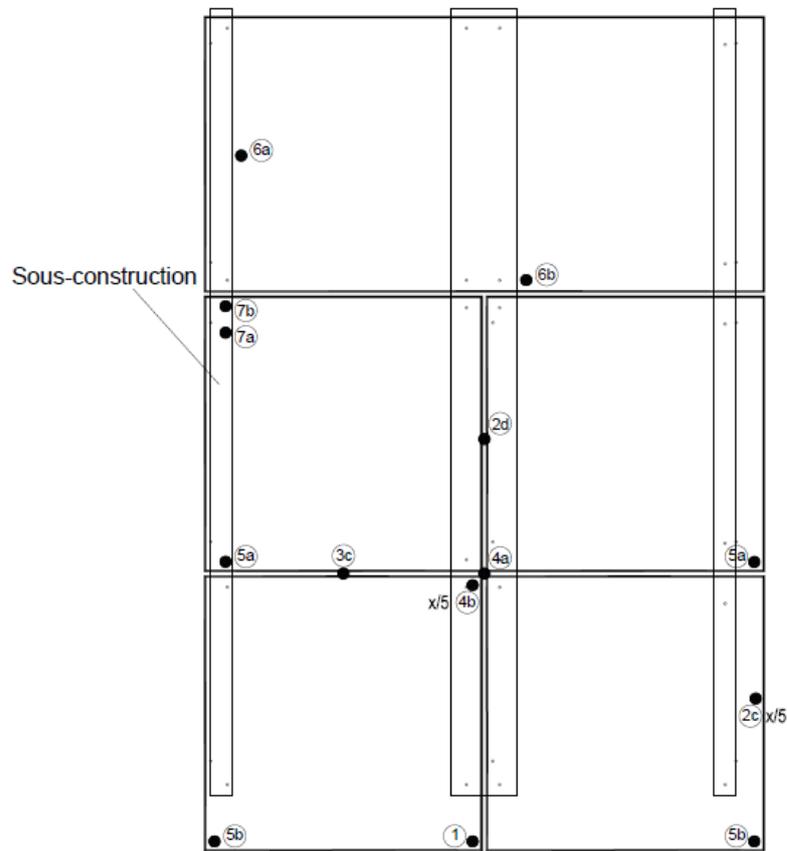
Points d'impact pour les éléments en fibres-ciment plats sous forme d'éléments de construction suspendus
